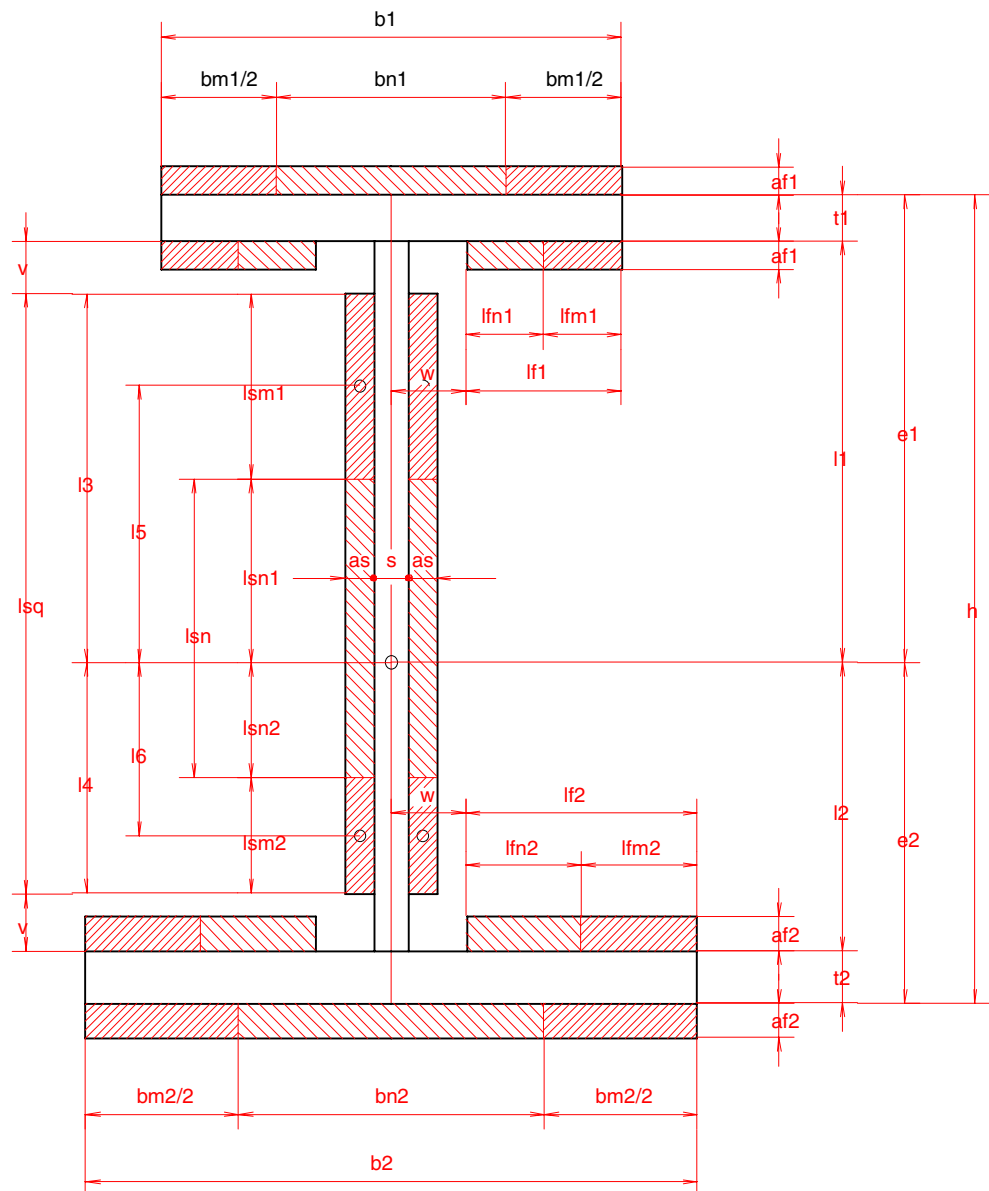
Bezeichnungen der Schweißnahtlängen
